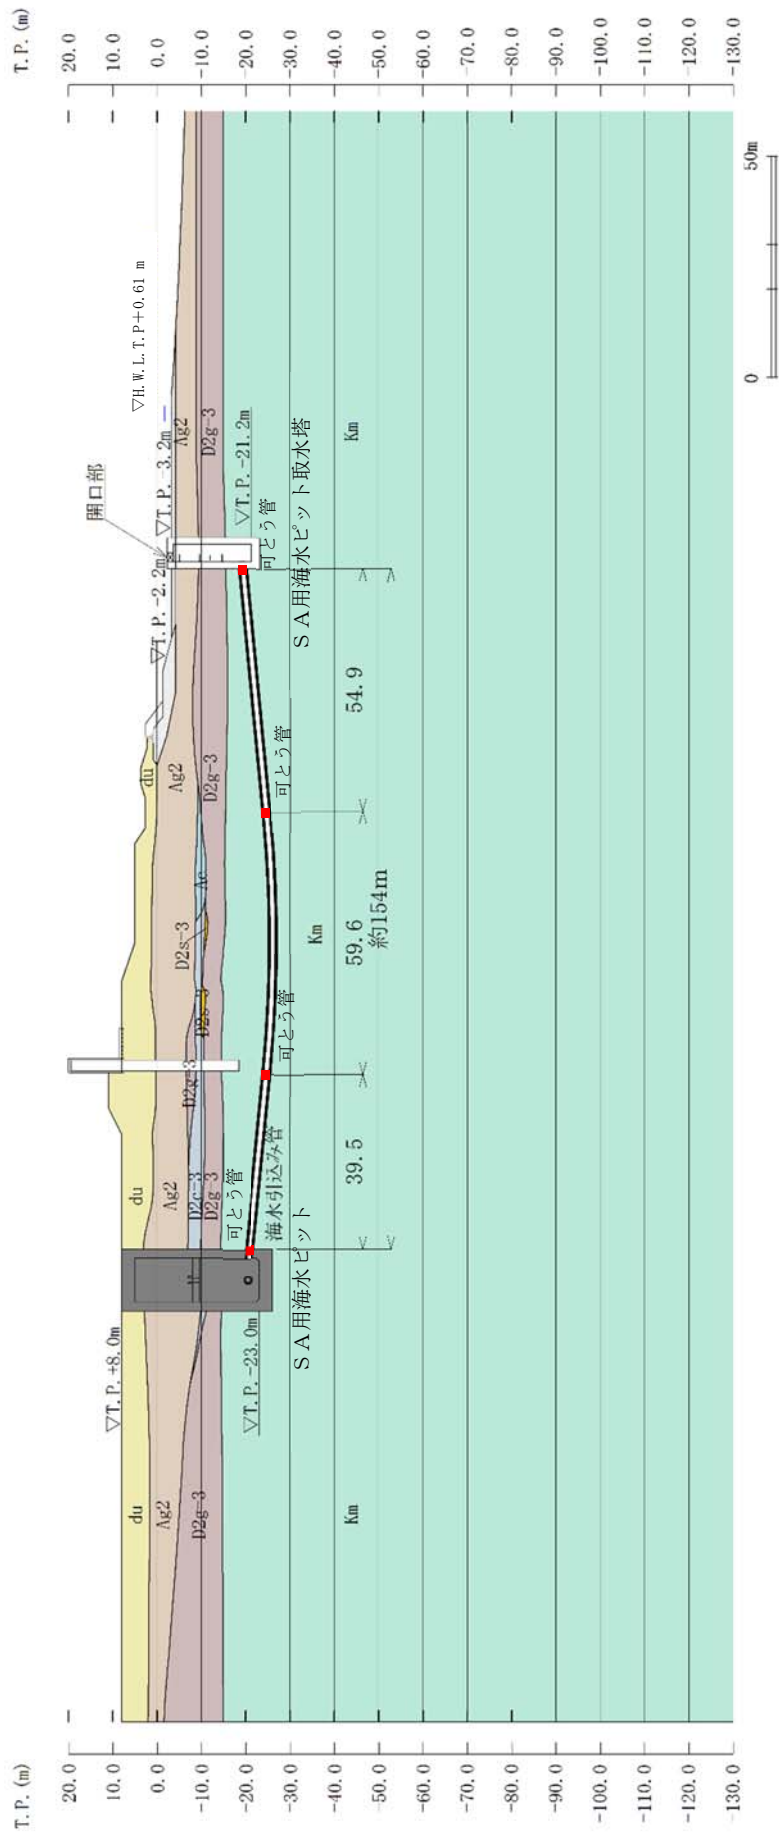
(1) SA用海水ピット 評価対象断面図 (①-①断面)
